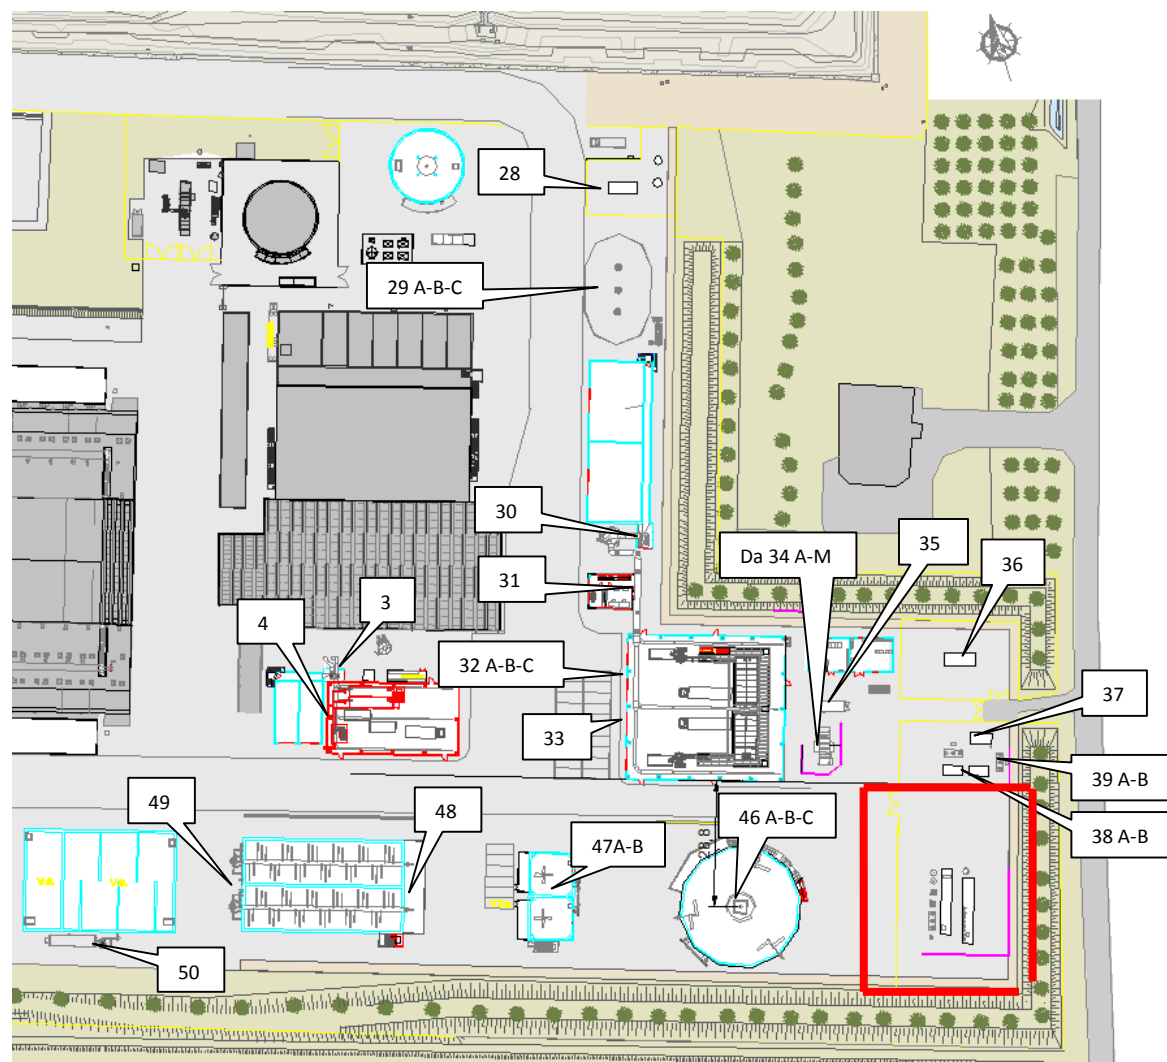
Vista planimetrica di disposizione impianti (Dettaglio 1)
